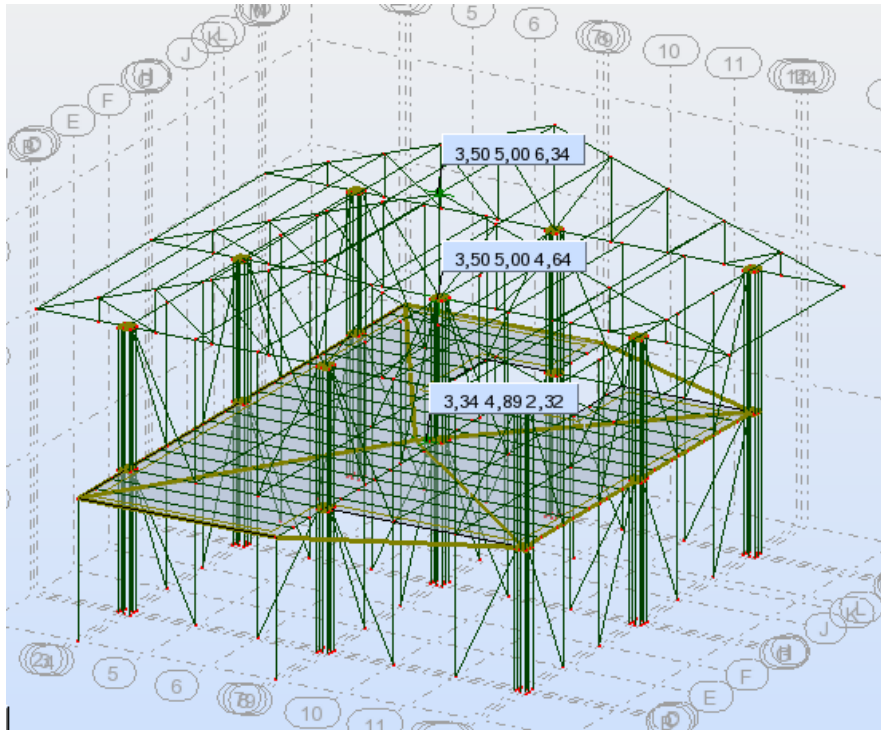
Coordenadas del centro de gravedad de cada losa de la estructura.
